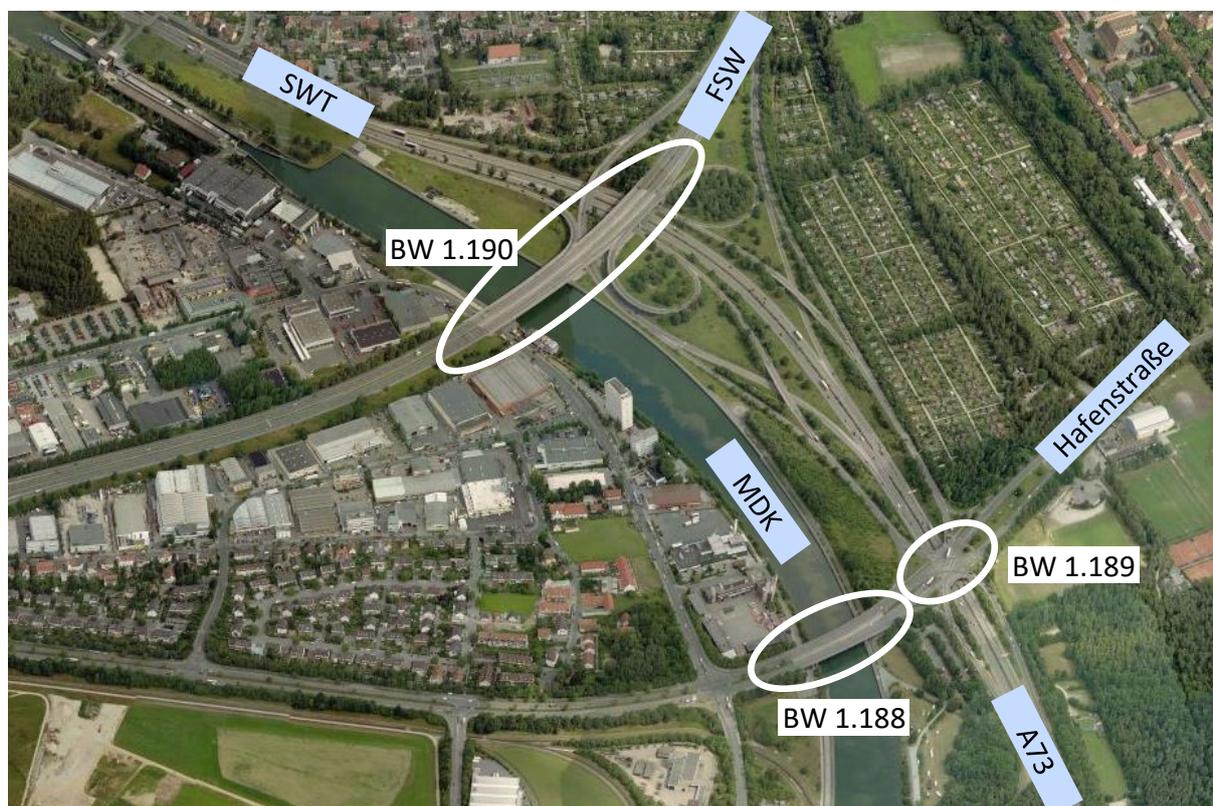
Planungsraum Ersatzneubau Brücken FSW und Hafenstraße [2]
